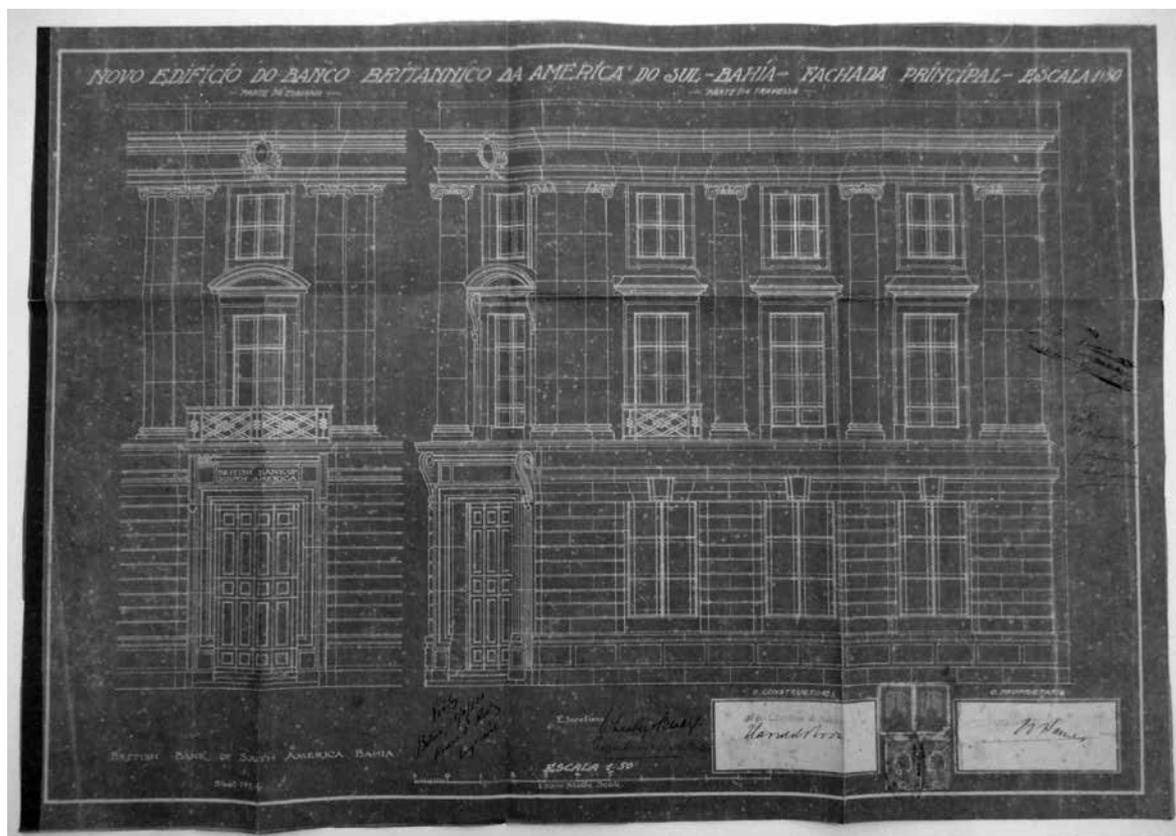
PROJETO DA FACHADA DO IMÓVEL (1925)
